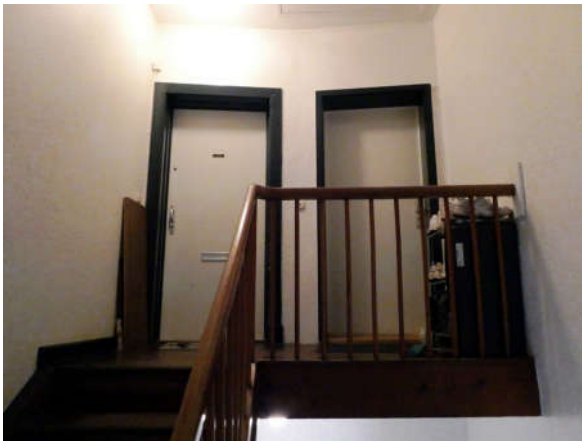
Nr. 24: Treppenhaus Bereich Dach
